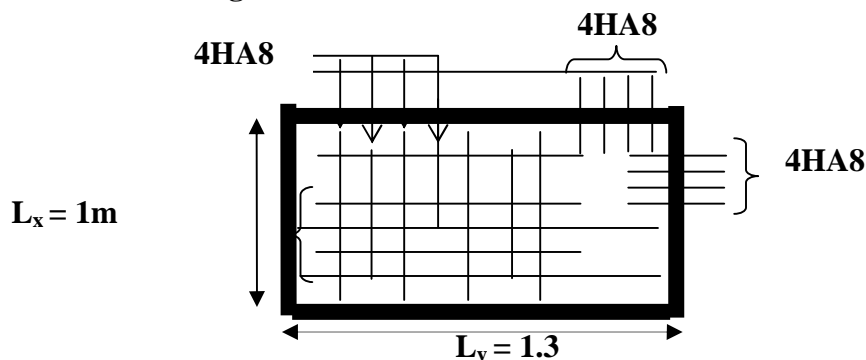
Schéma de ferrailage de la dalle sur 4 appuis
